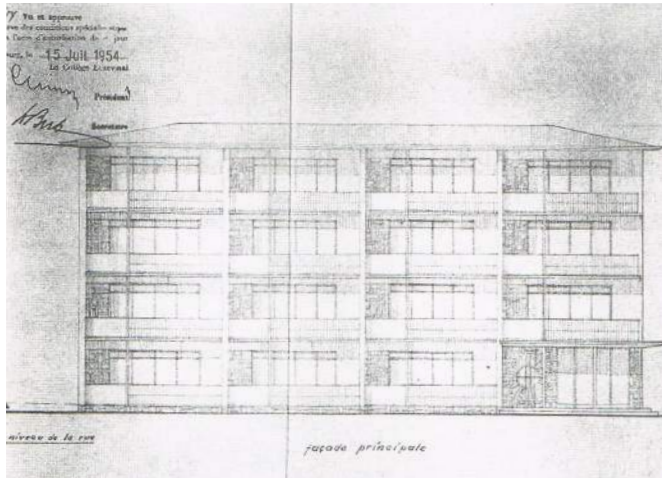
Hauptfassade geplant mit Walmdach (1954)
